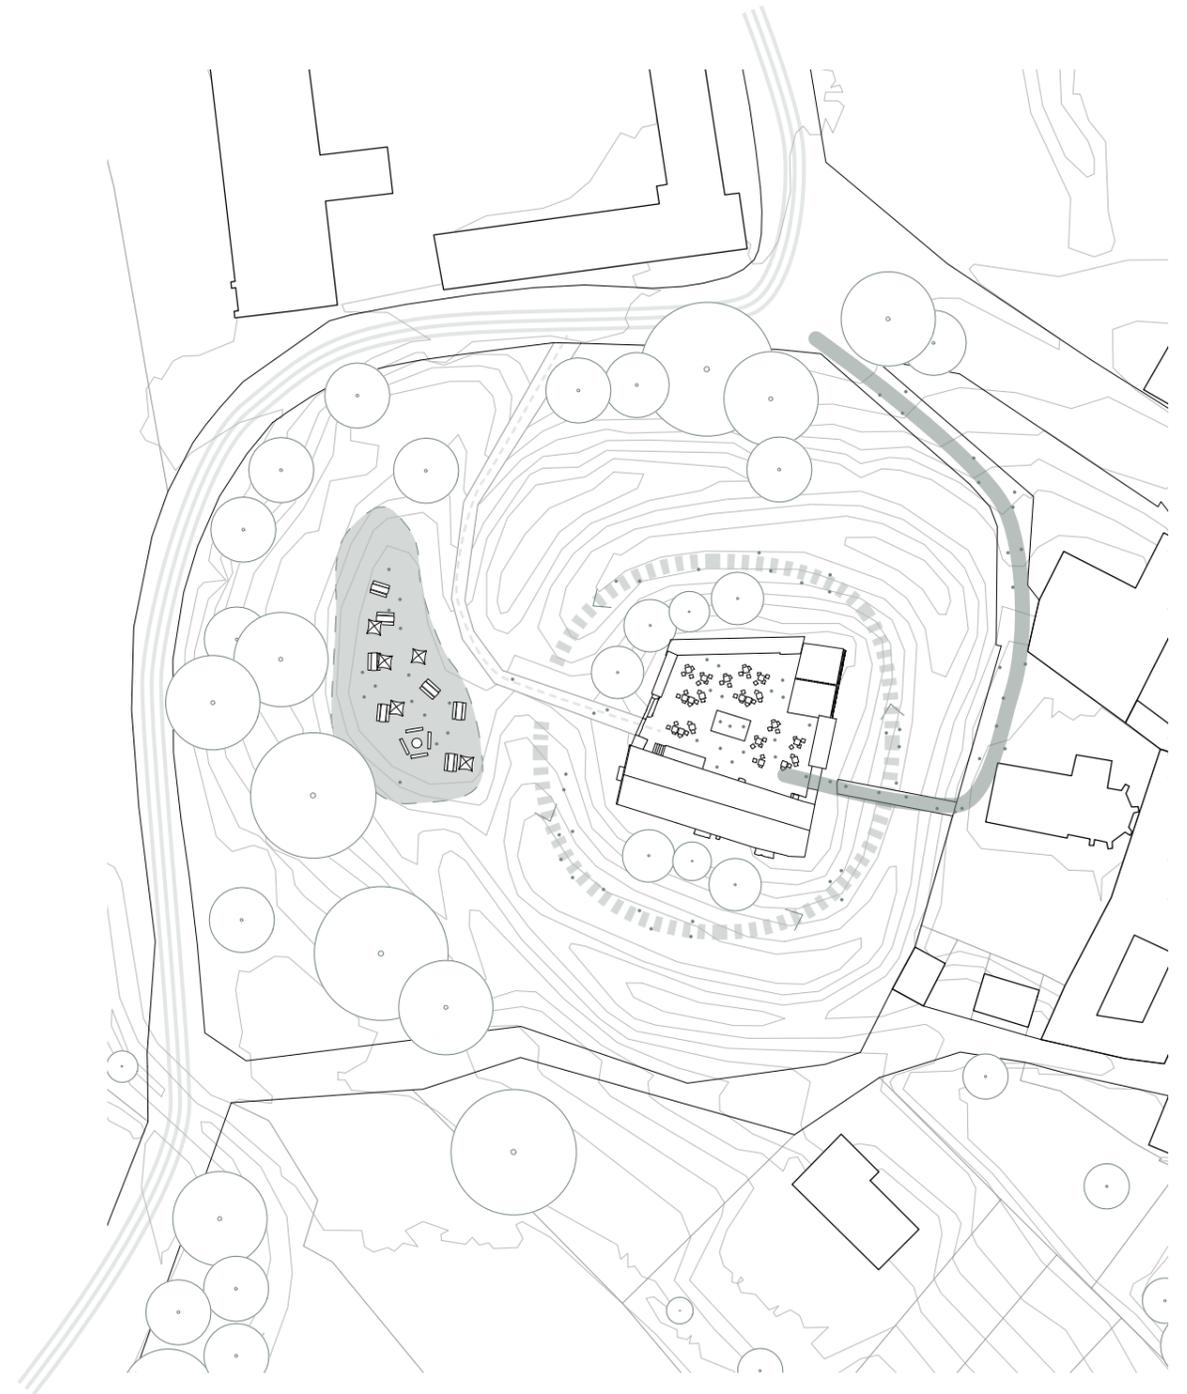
Gegenwärtige Wegeführung 2019, Lageplan Oberrußbach, M 1:1000
